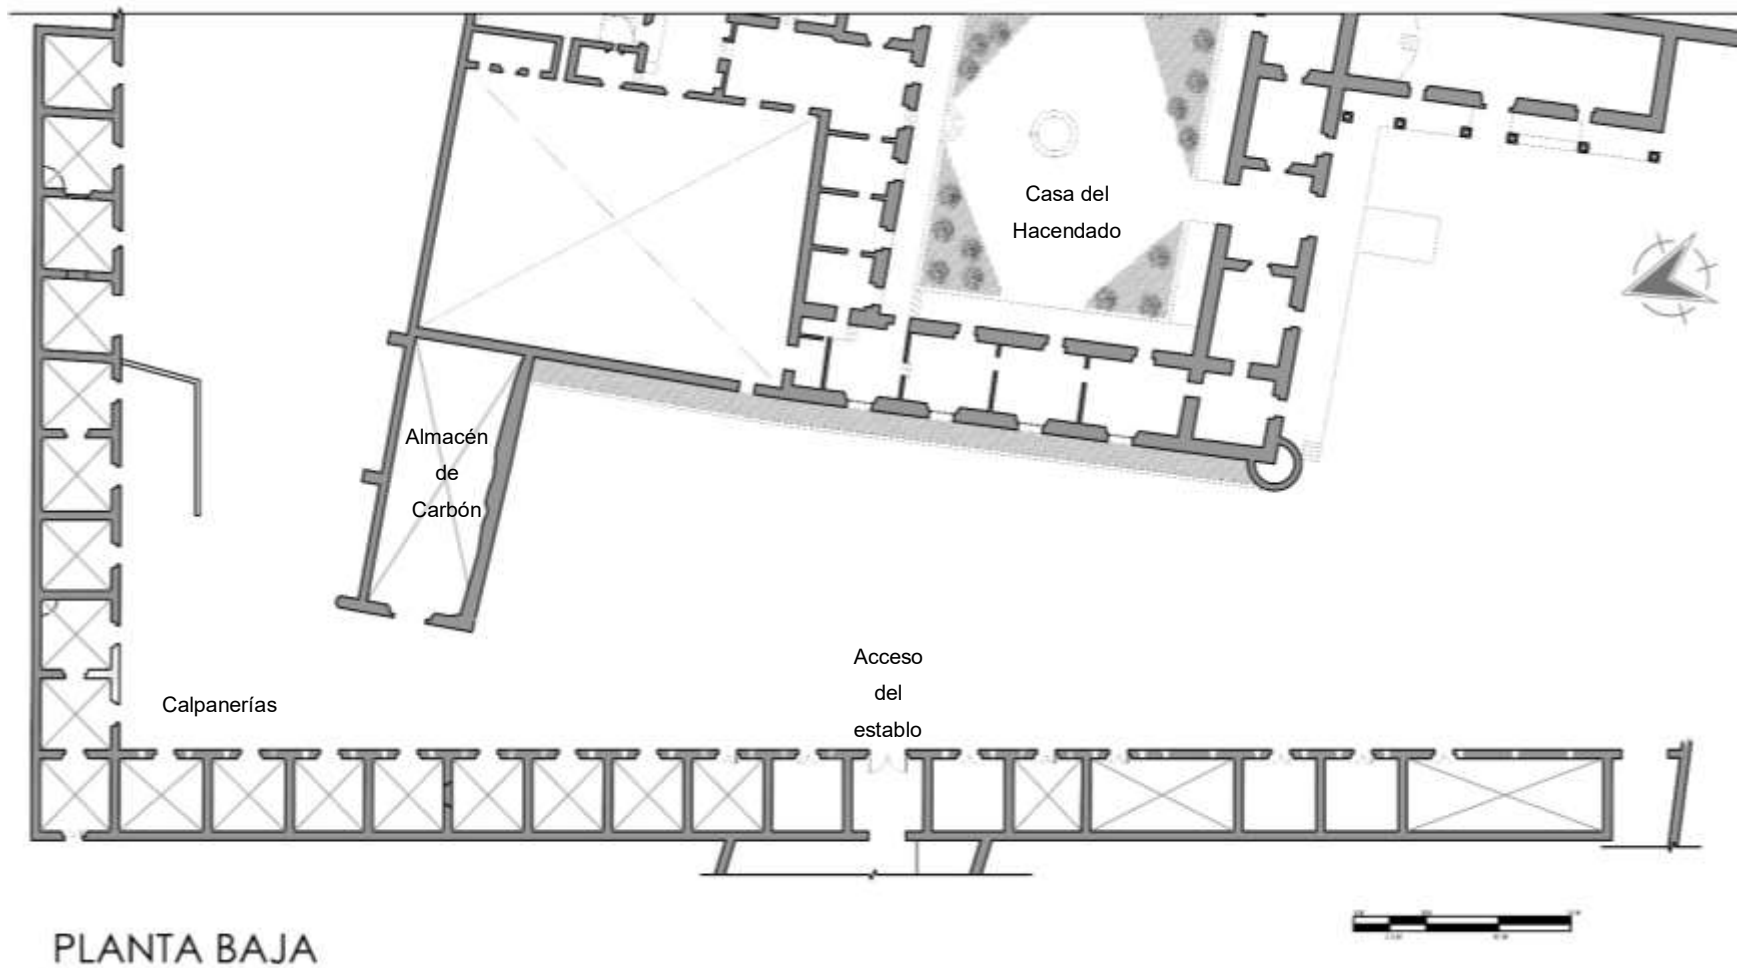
Plano de la Planta de las Calpanerías y Almacén de Carbón.
